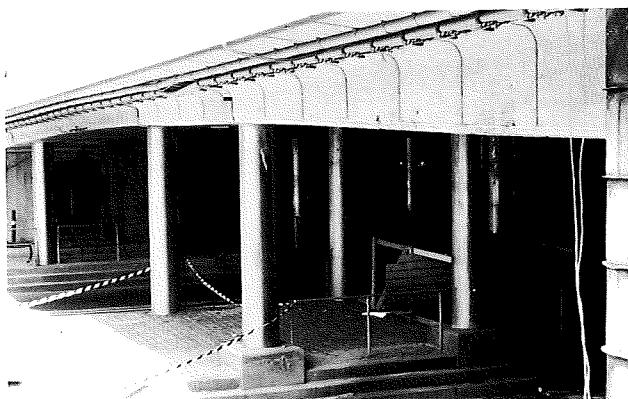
Columna de hormigón armado revestida de acero inoxidable expuesta a frecuente deshelado por sal.
